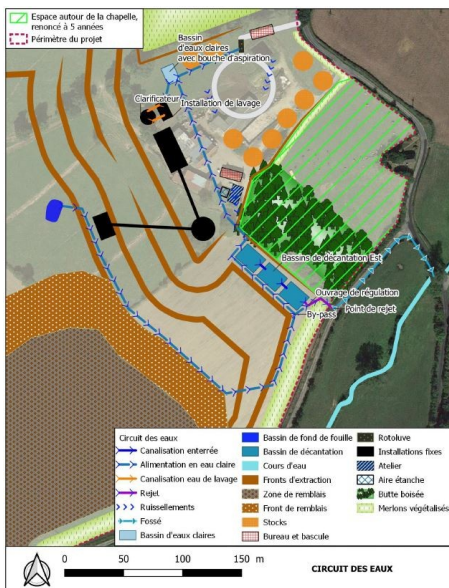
Plan de traitement des eaux (source : p. 43 VH)
